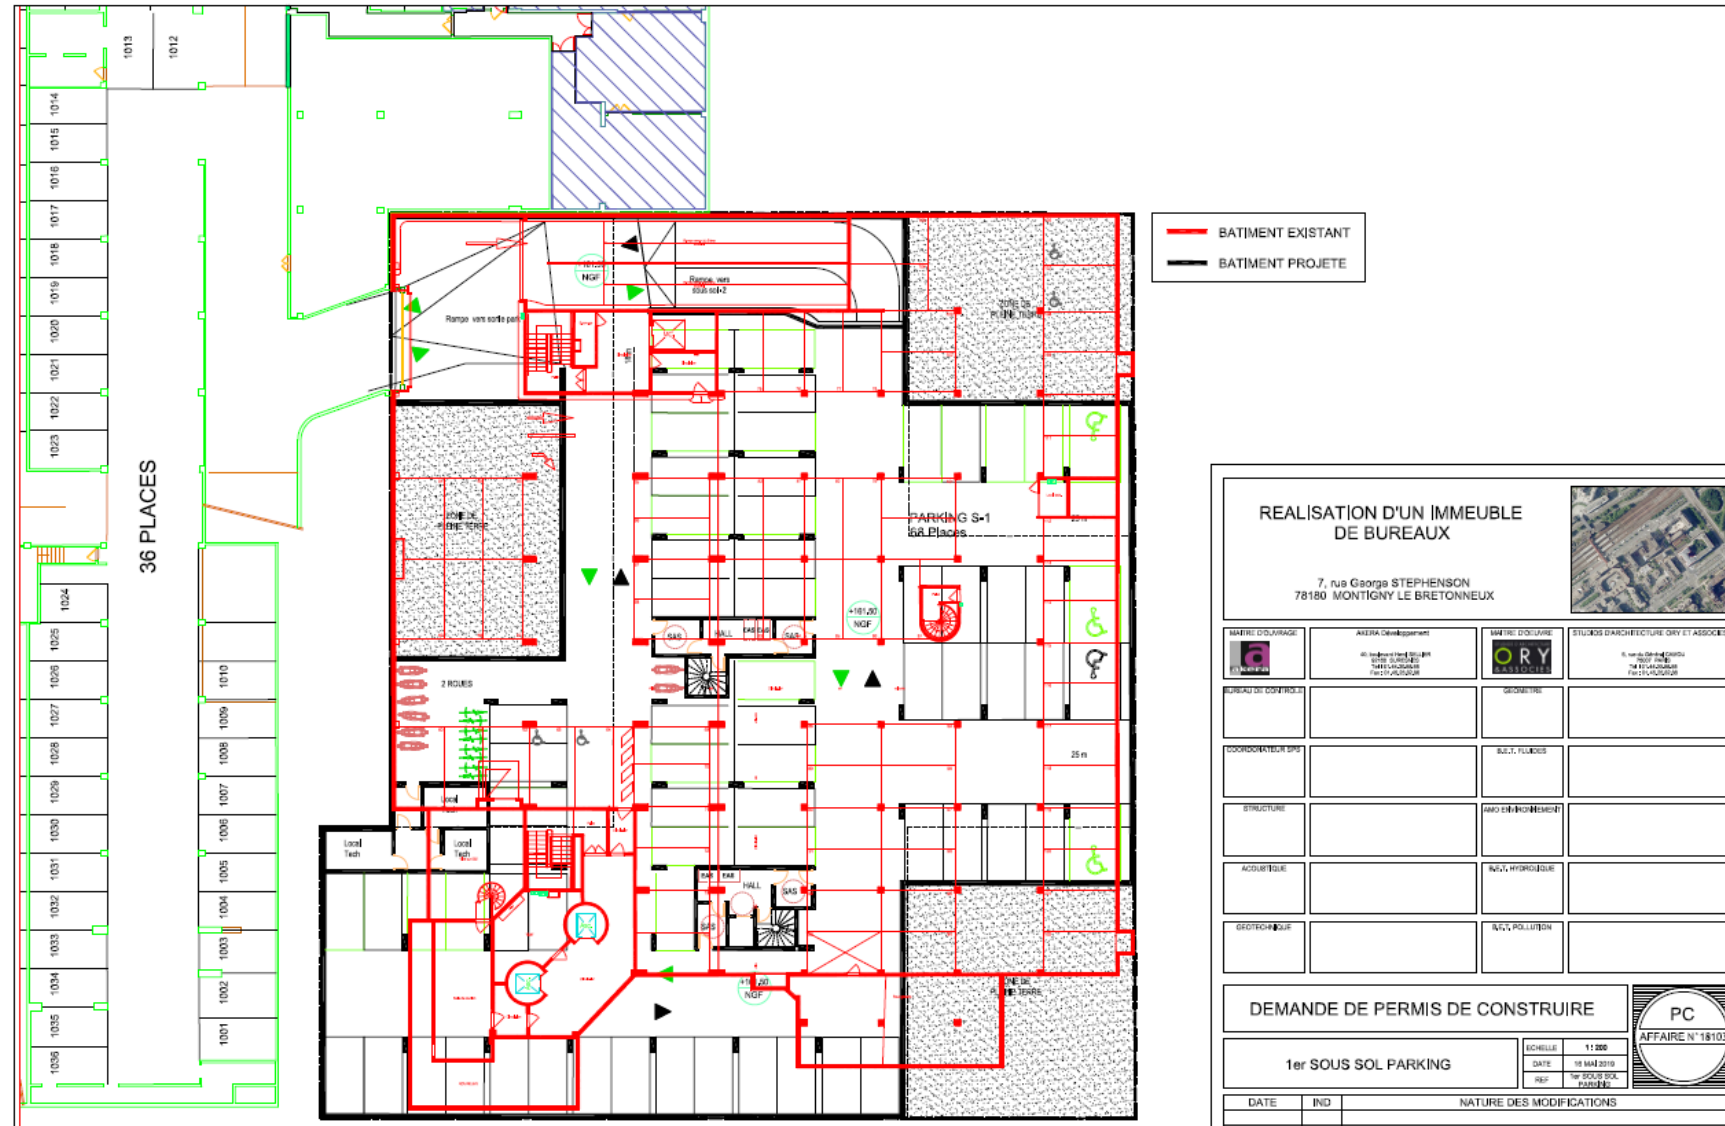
Superposition des plans du 1^{er} niveau de sous-sol existant et projeté (Source : Studios d'Architecture ORY & Associés)
